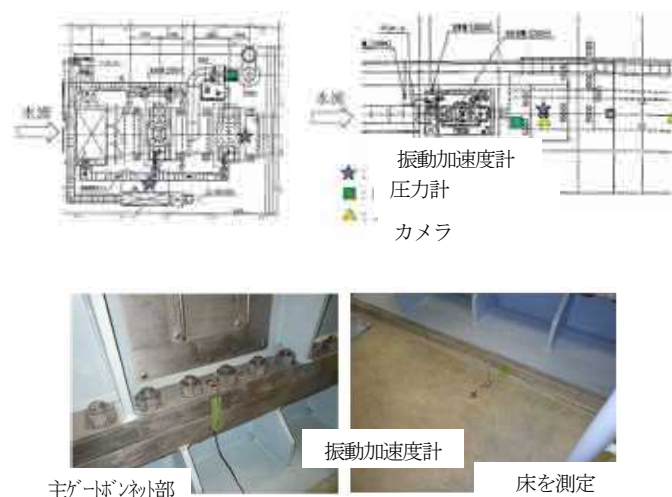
計画水位維持放流設備 平面図・減勢槽平面図
